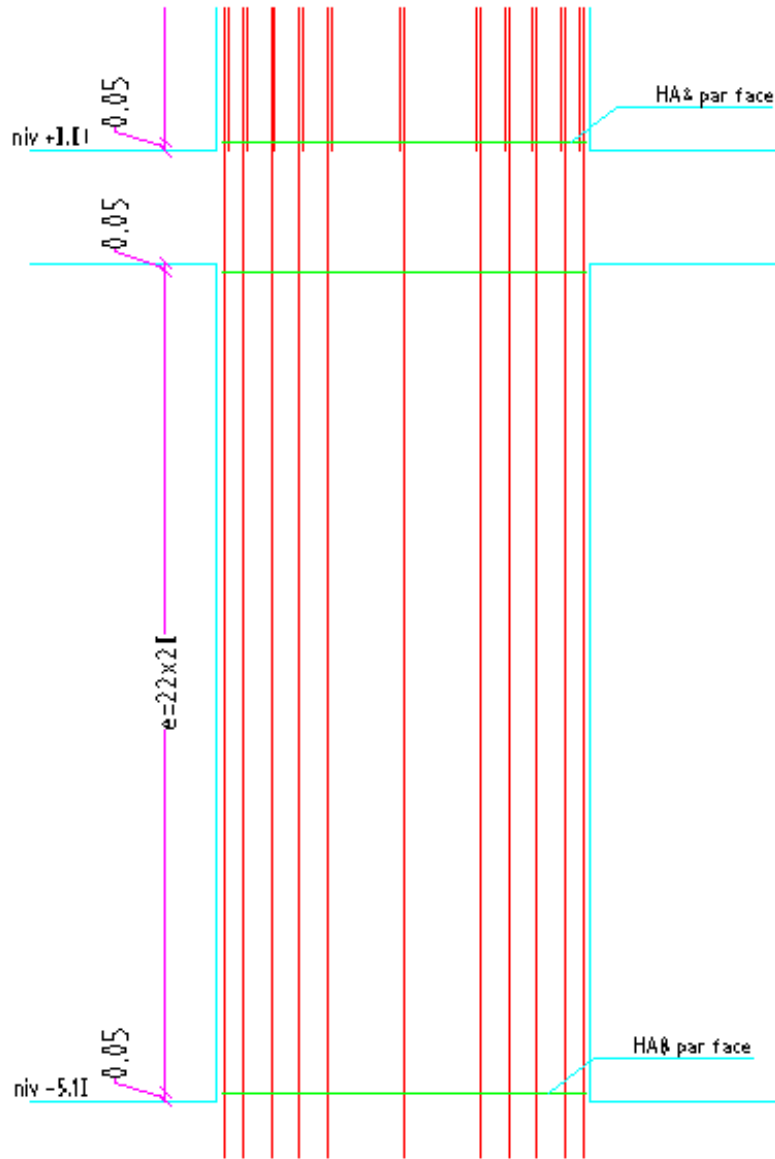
Ferrailages du voile plein coupe longitudinale
